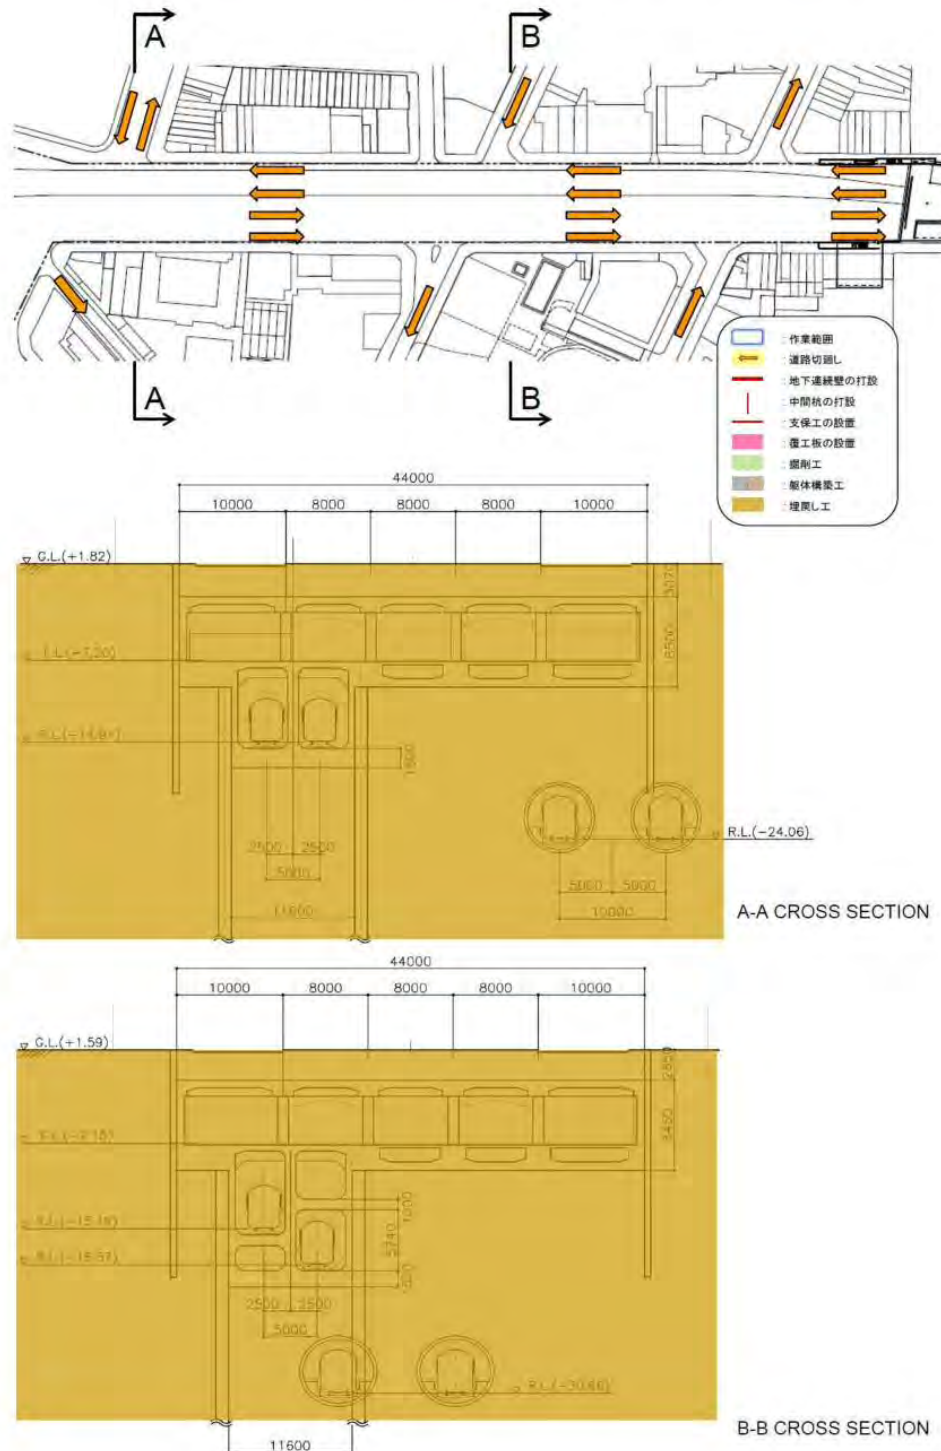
レロイ通り地区の都市鉄道1号線と地下街の施工手順図 (その1/14)
